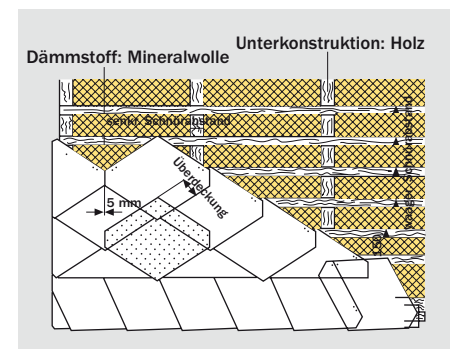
Holz-Unterkonstruktion, hier: Zweifachlattung mit kleinformatiger Bekleidung in Rhombus-Schablonen-Deckung
